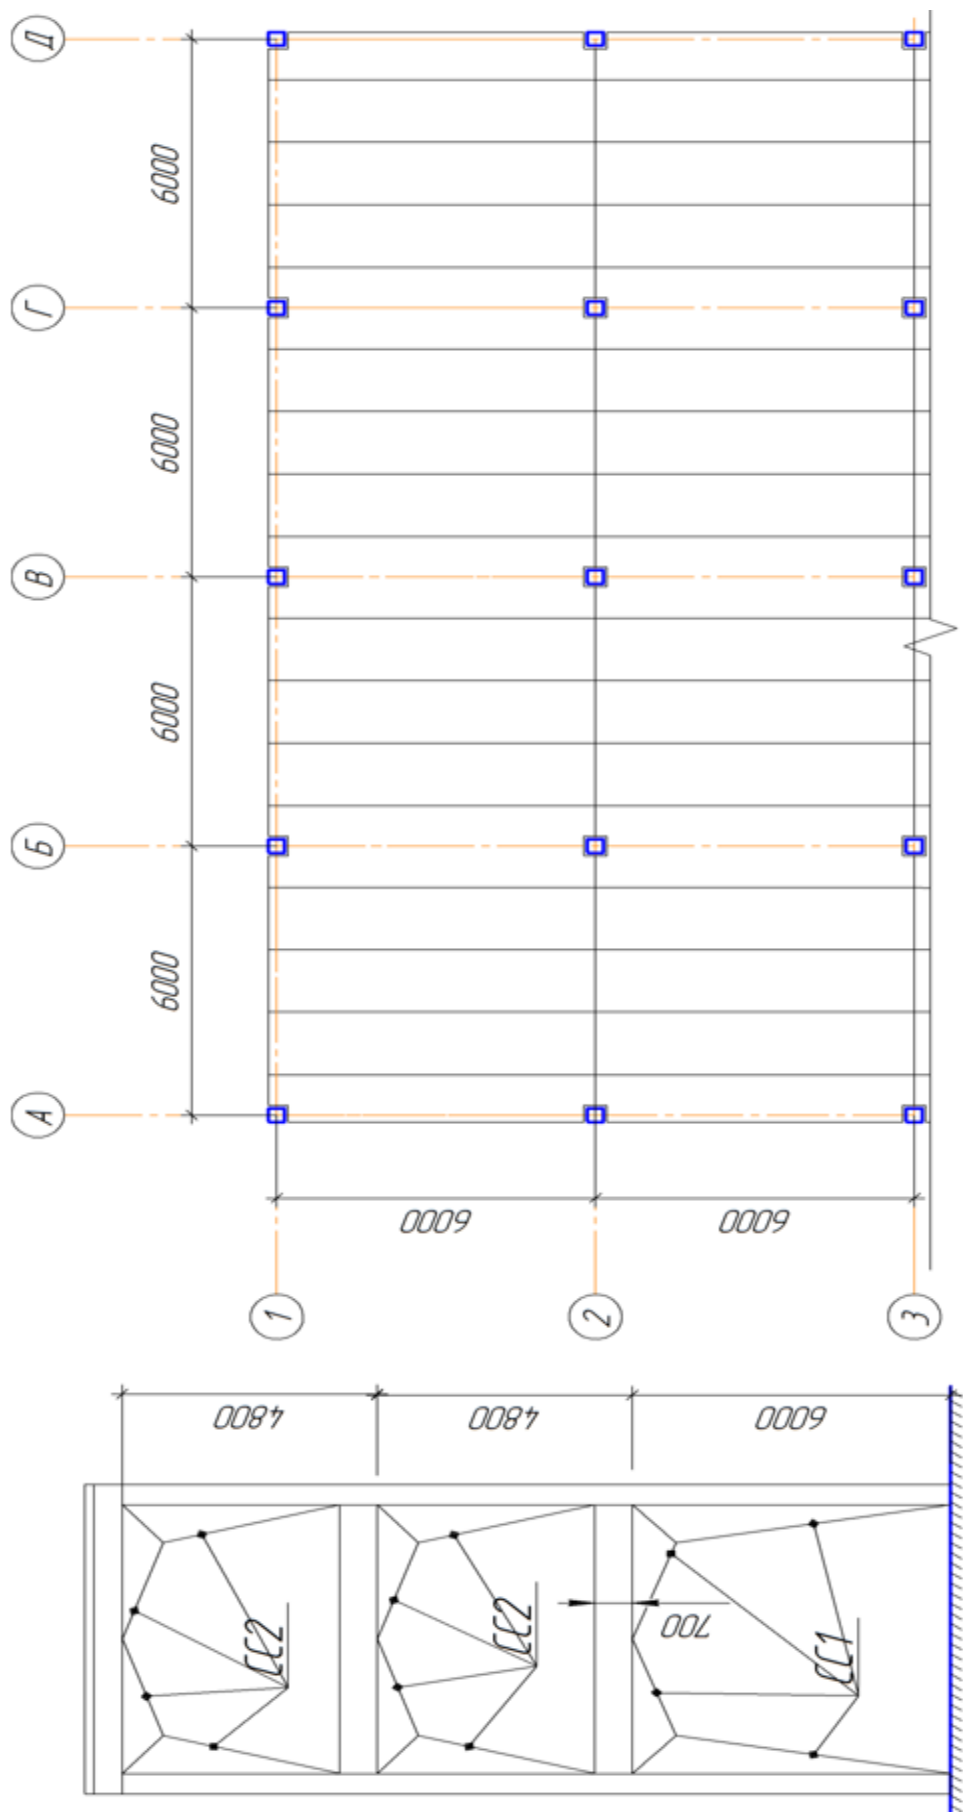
Схема розкладання плит перекриття і встановлення вертикальних зв'язків
